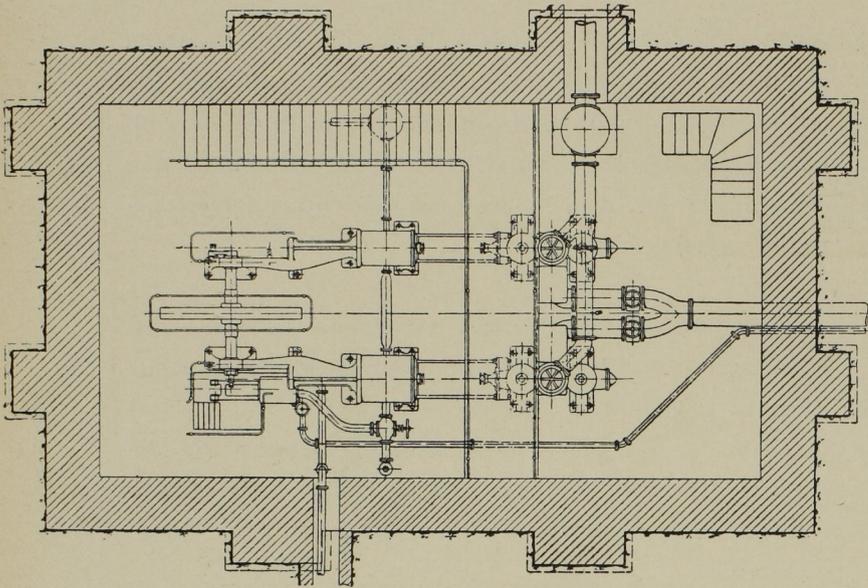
Grundriss der Dampfmaschine und Pumpe. Masst. 1 : 150.
